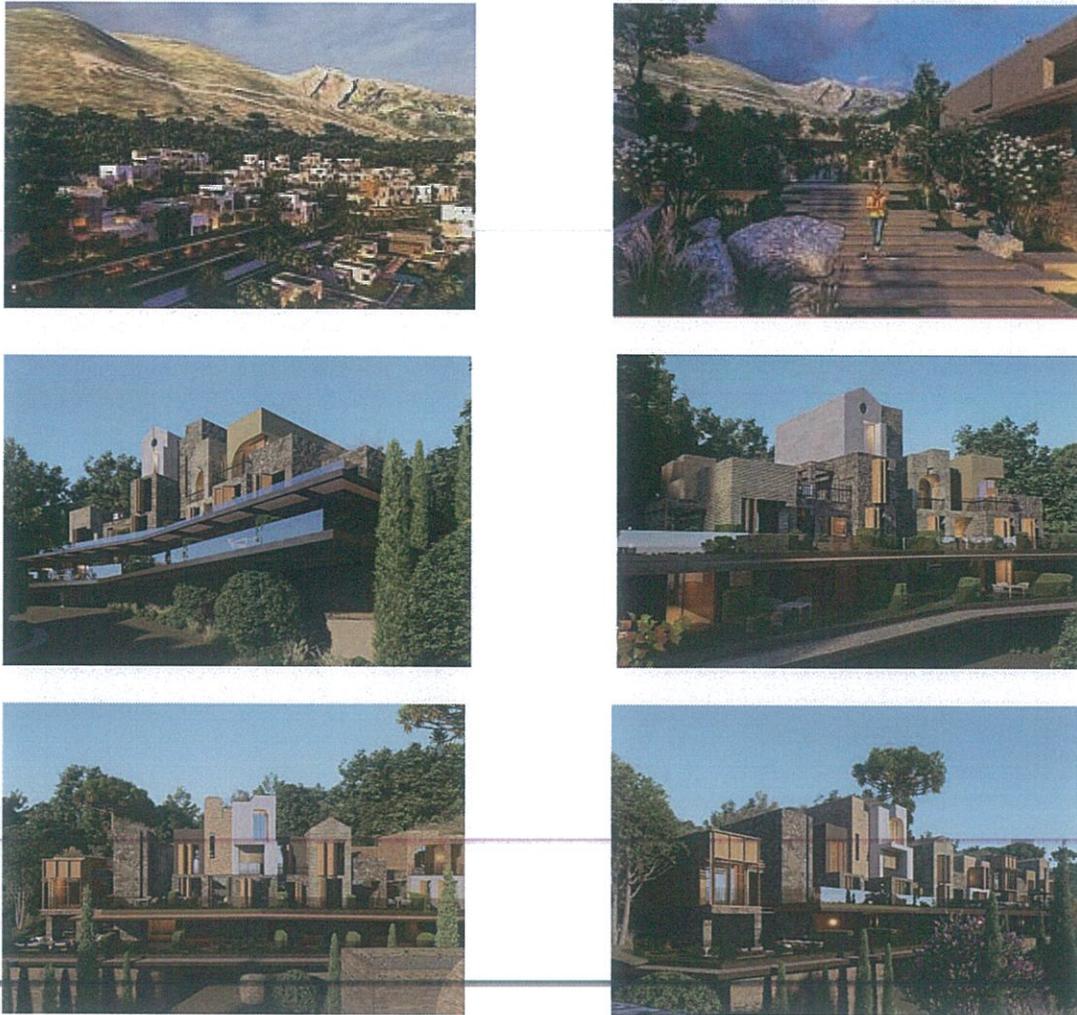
Tipologjia apartamente pamje render dhe prerje skematike
